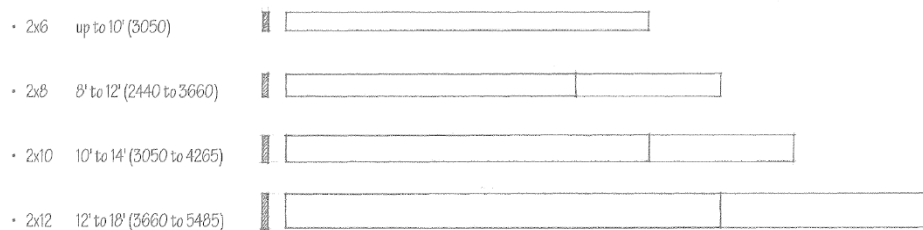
Vãos indicativos em função da secção das vigotas de pavimento (Ching, 2008).
